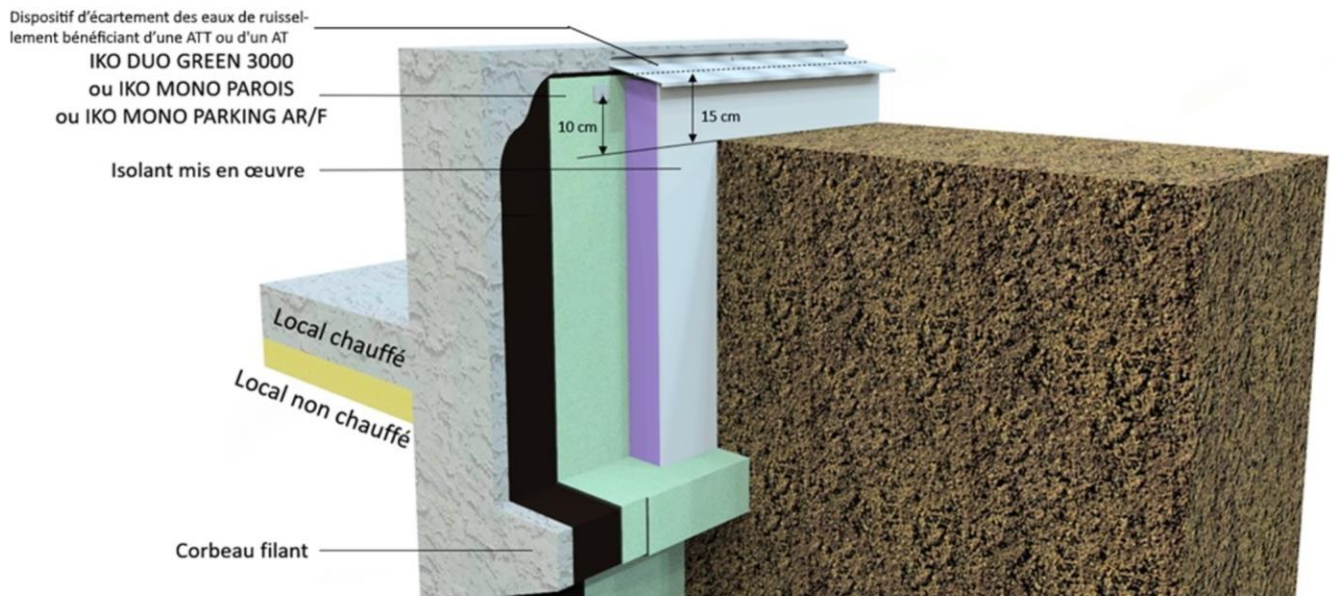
Protection en tête d'une paroi enterrée isolée (cas du corbeau filant)
